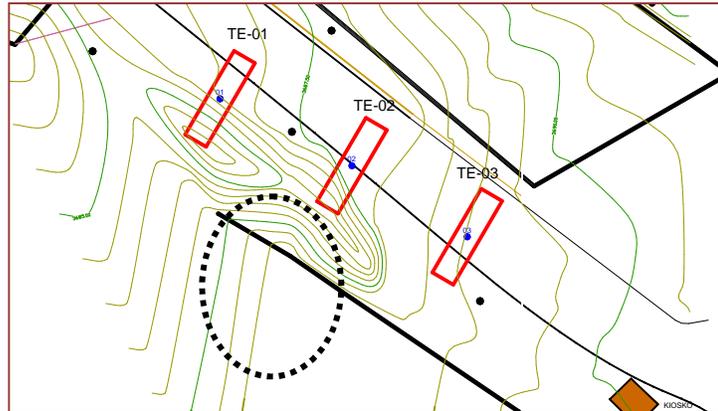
Plano de ubicación de la trinchera de excavación N° 02 dentro del círculo
